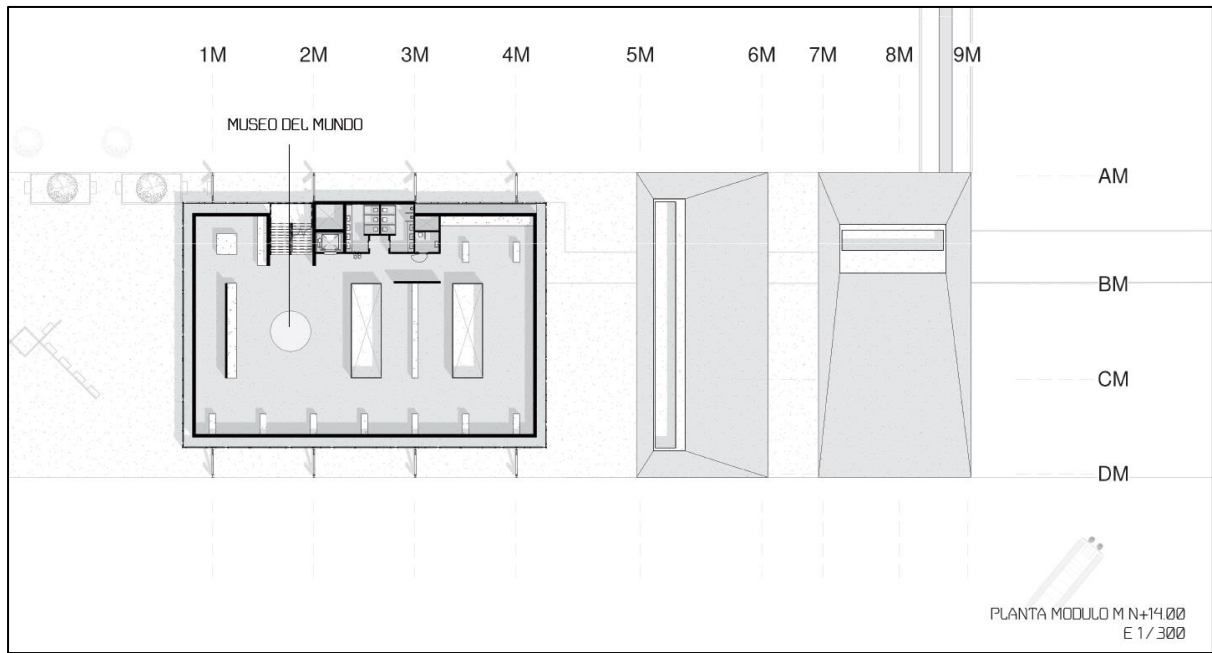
Planta N+14.00 Módulo M. Elaboración propia.
